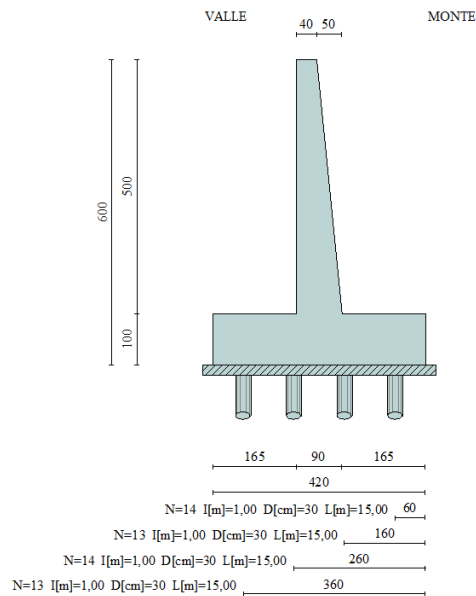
Muro Tipo C: geometria del muro di sostegno.
